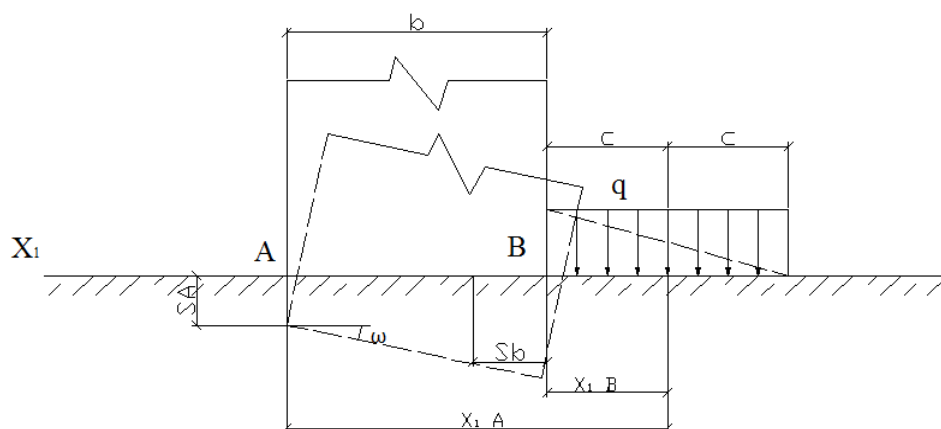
Схема к определению крена сооружения от пригрузки
